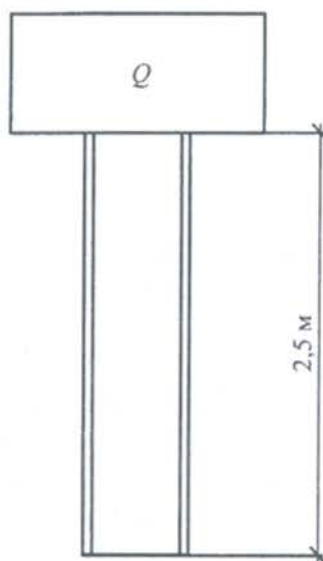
Схема образца для испытаний стальных конструкций
